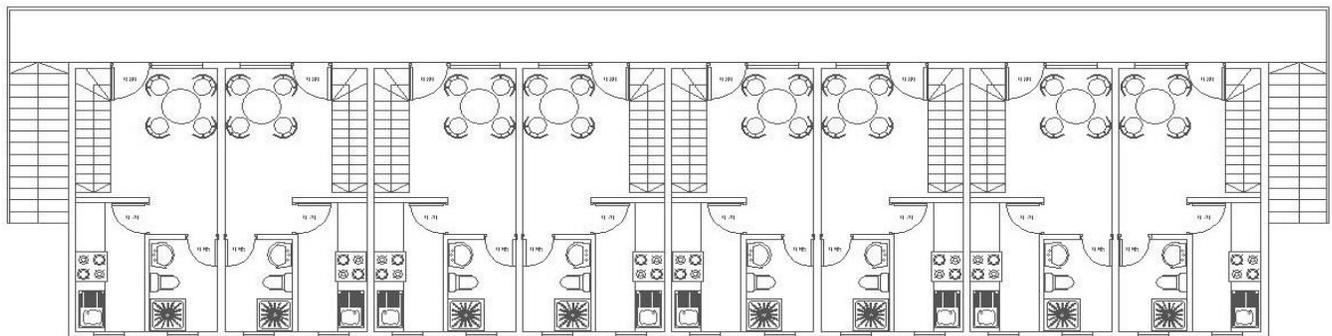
Planta Arquitectónica, Villa Las Viñitas, Elaboración propia.
